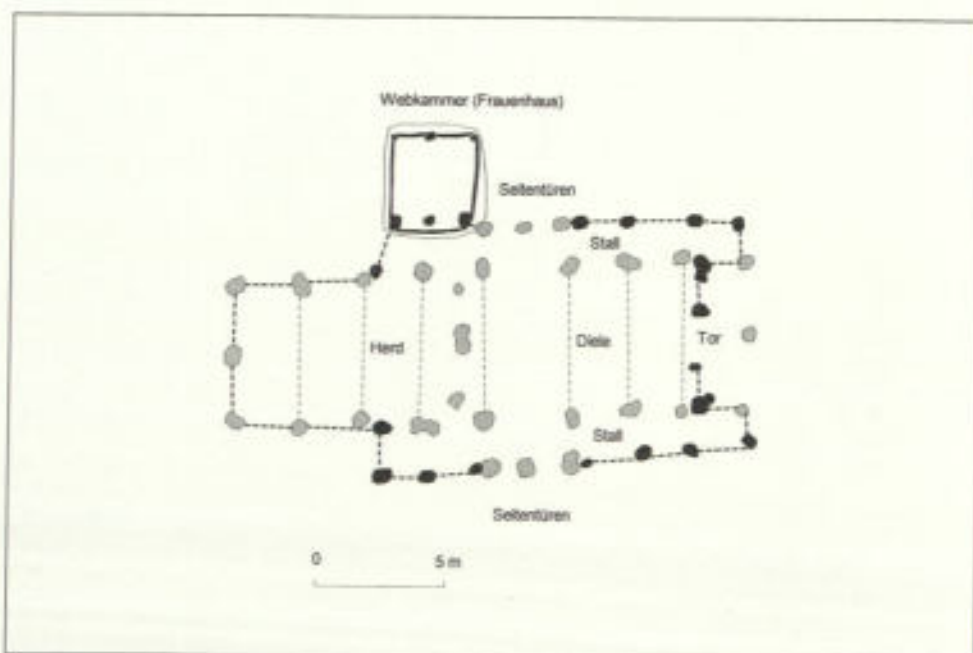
Grundriß des Telgter Hauses (vgl. Abb. 8) nach dem Umbau zum Hallenhaus.
